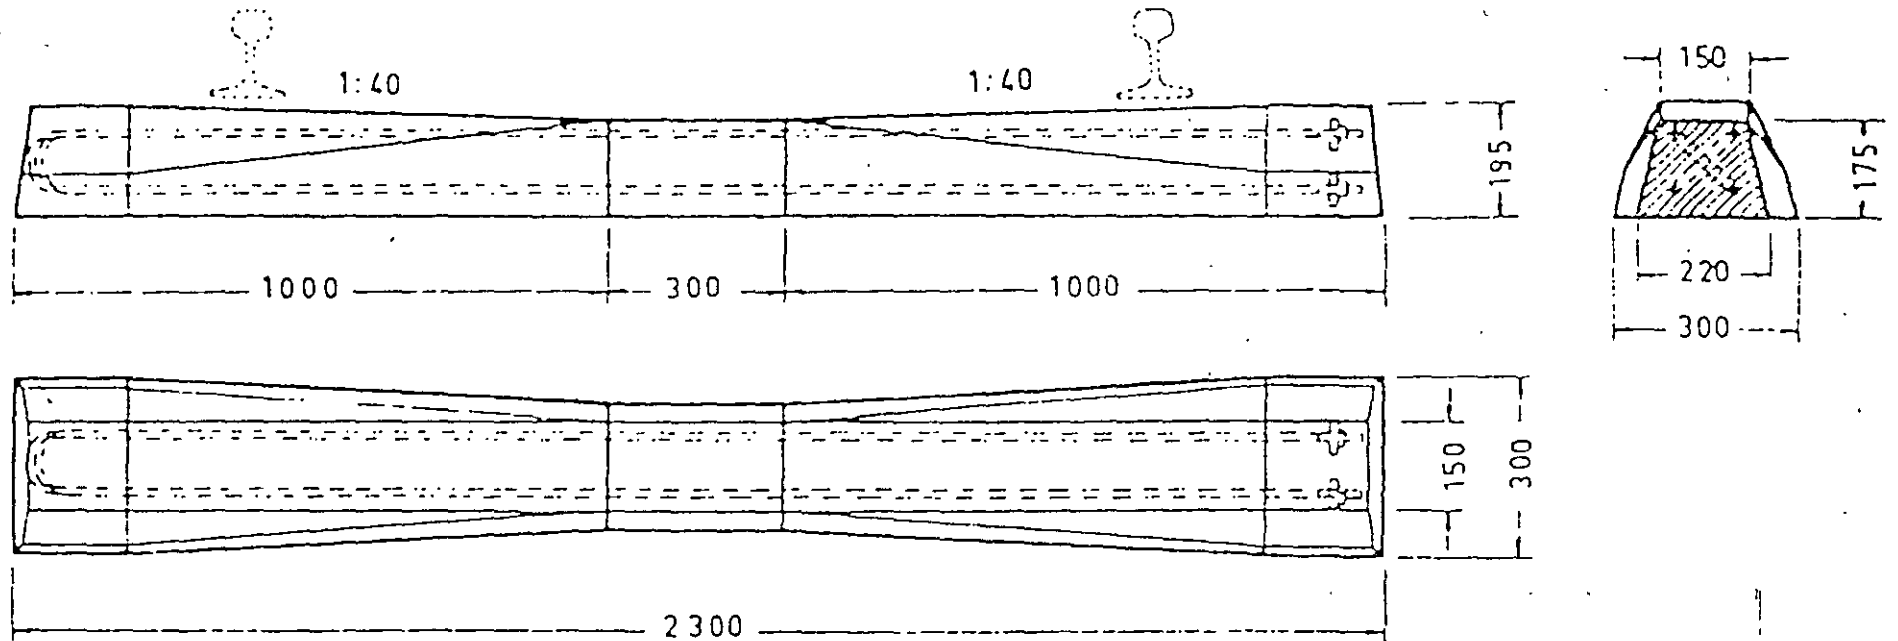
DURMIENTE DE CONCRETO POSTENSADO.
